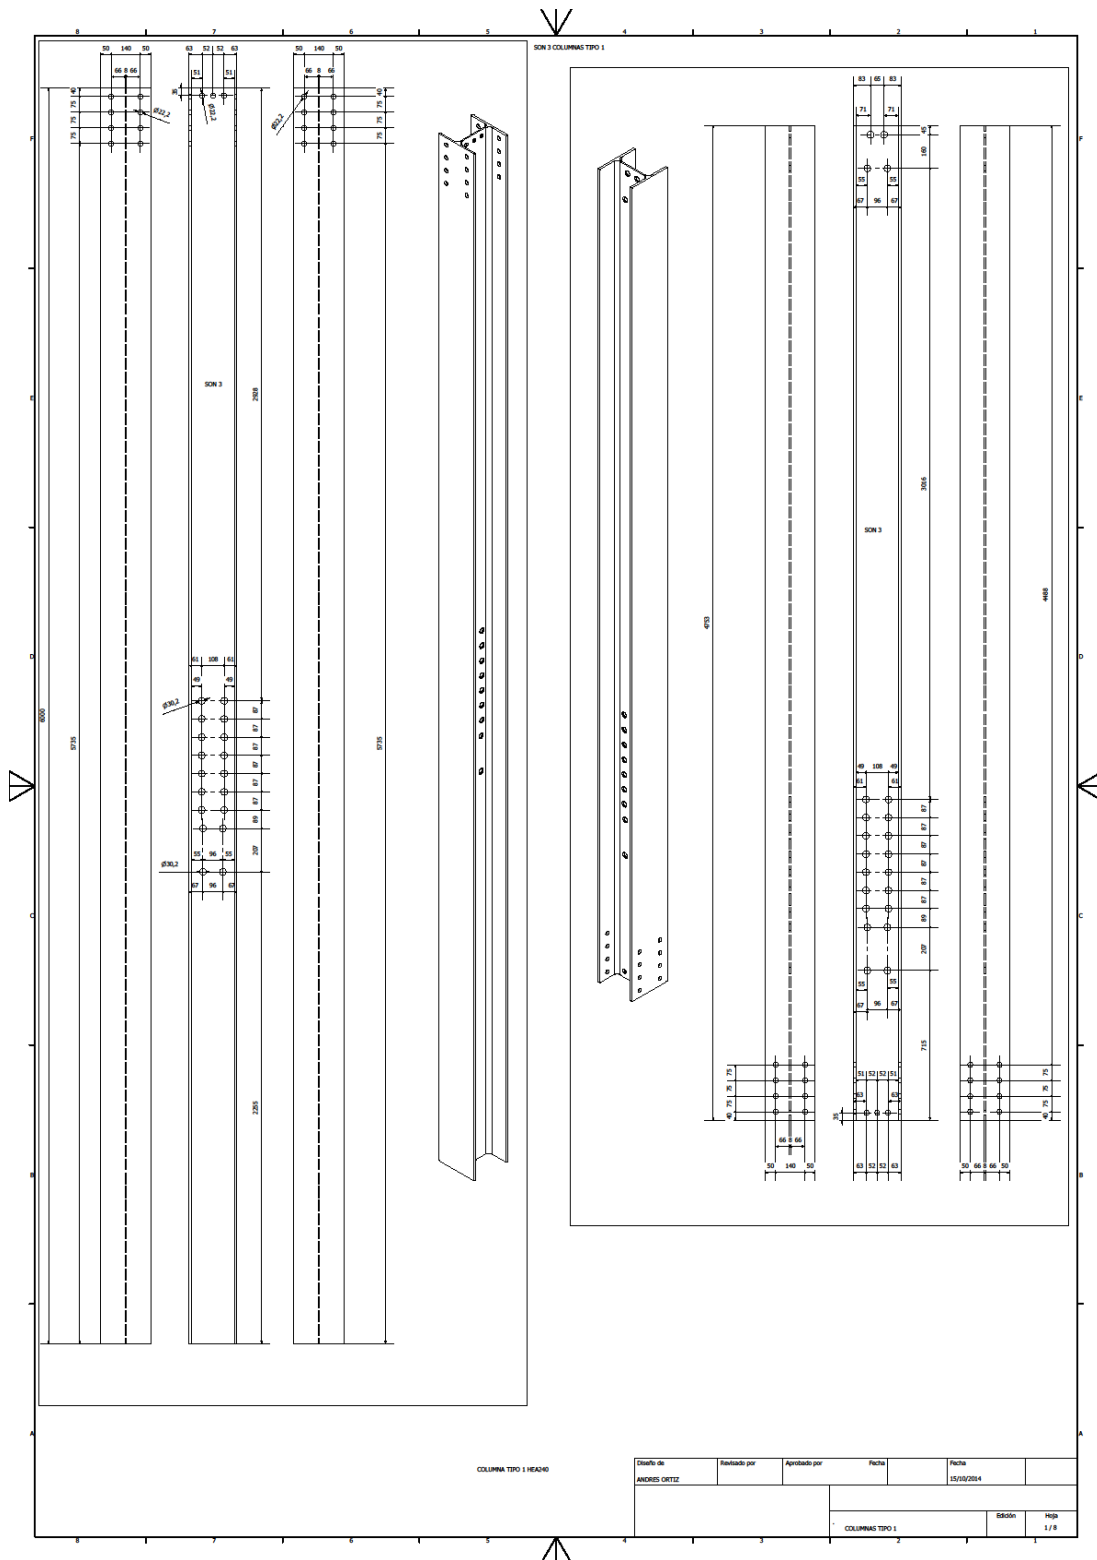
Planos de taller Columnas Tipo para Refuerzo Estructural Col. San Pedro.
